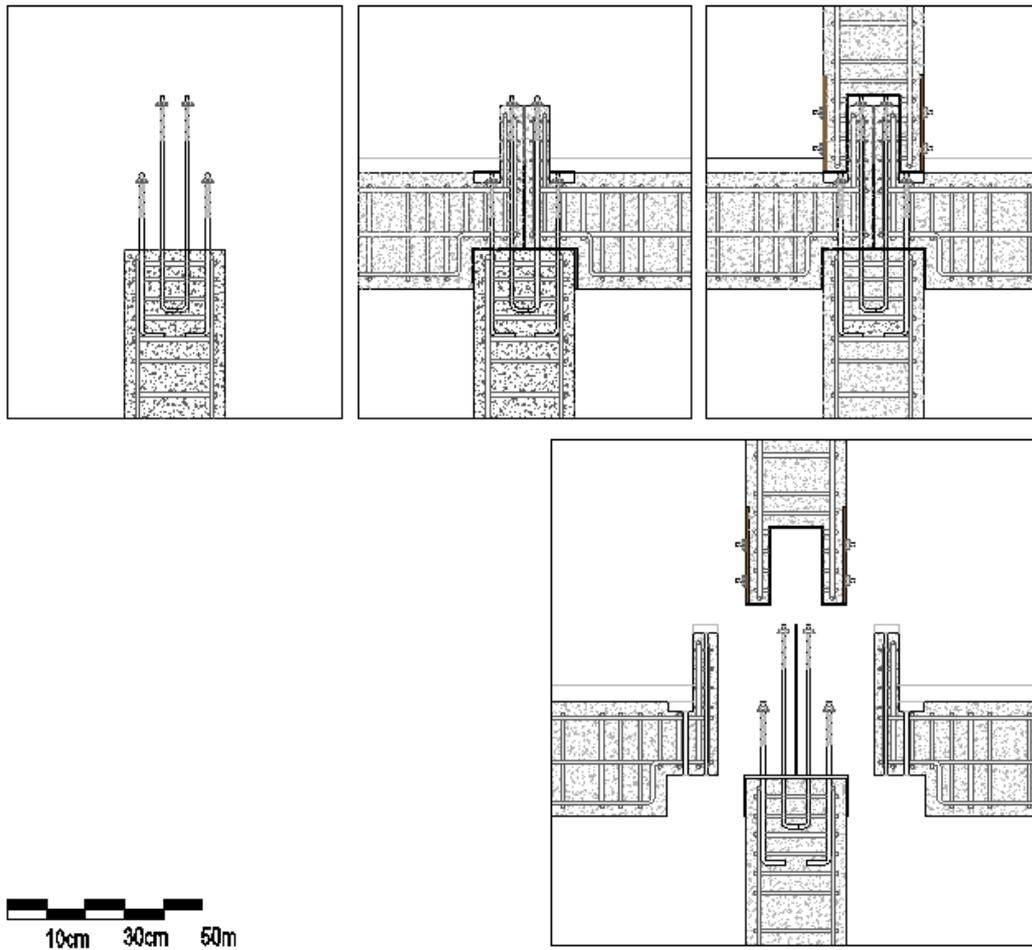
Proceso de unión estructural en pilar tipo 2 y 3.
